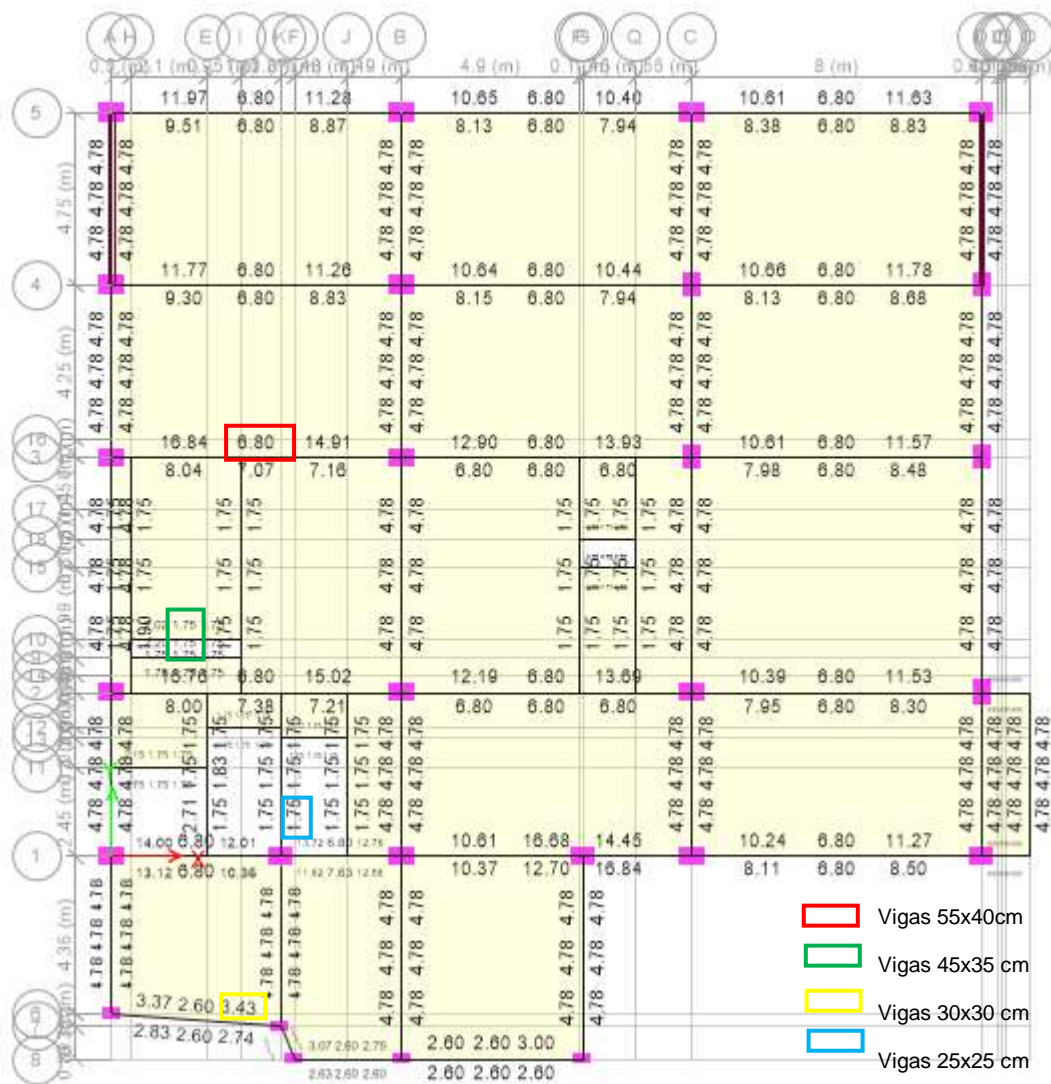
Tipos de vigas en la edificación con su recubrimiento.
